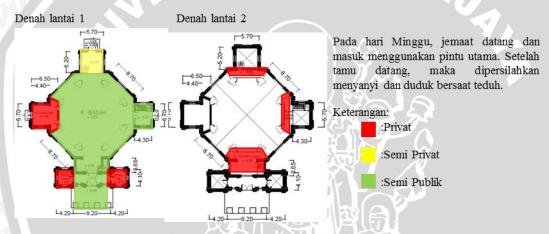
Denah eksisting lantai 2 Gereja Blenduk tahun 2015
